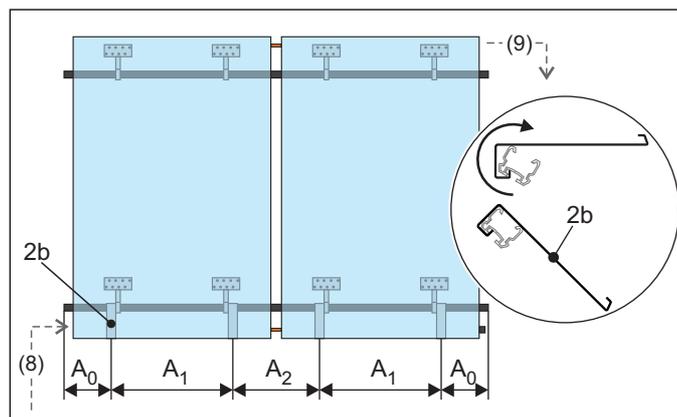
Fase di lavoro 1: allineamento dei ganci di fissaggio
